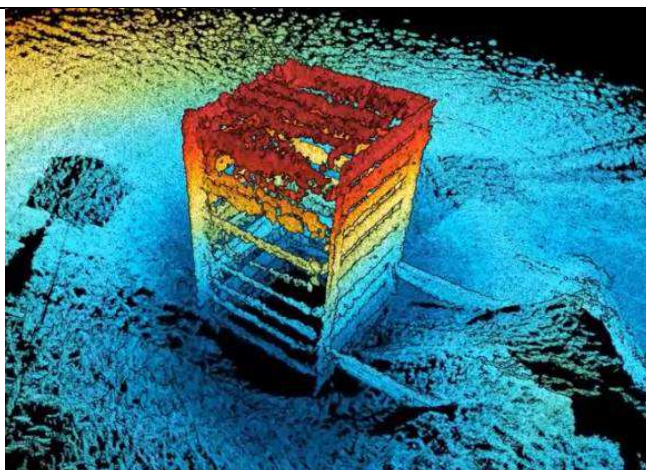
Observation au scanner 3D de l'entonnement du conduit de vidange de fond du barrage de Plan d'Aval
